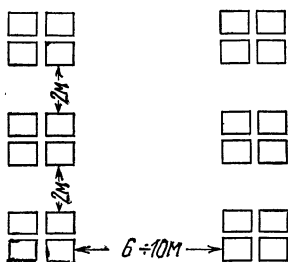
Схема расположения барабанов на кабельной площадке
